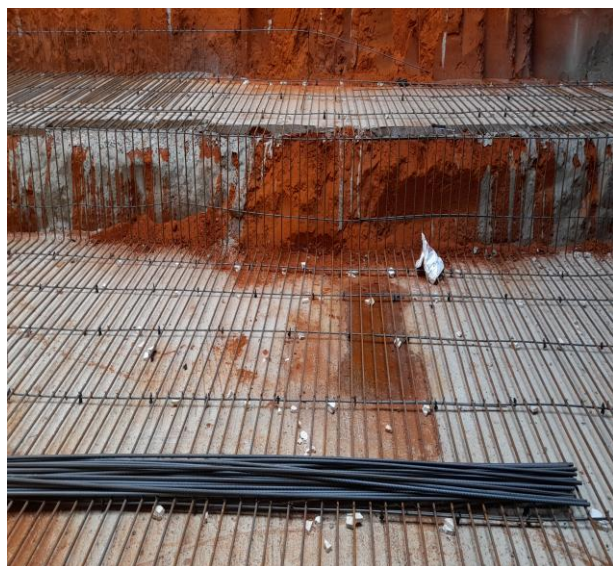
Colocação da armadura inferior(Fonte: Autor)
